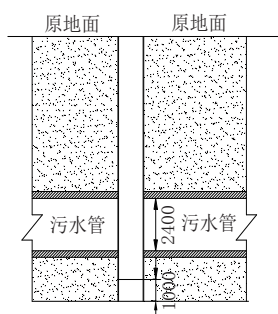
钢套管、钢护筒与污水管相对位置关系剖面图(单位:mm)
